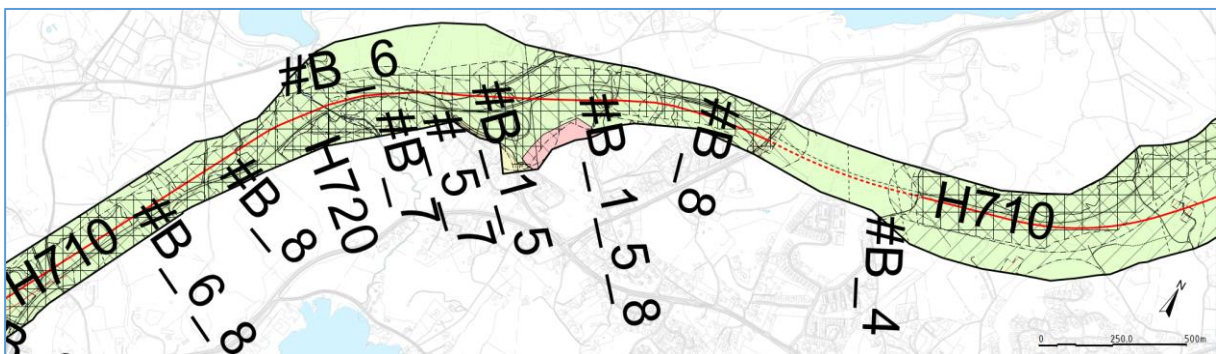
Forslag til endret kommunedelplan på delstrekning Tingstveit–Hausland. (Kilde: Sweco)
